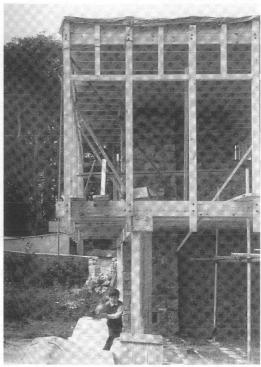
El pabellón en construcción. Detalles del apoyo del entramado de madera sobre la viga de hormigón armado. Simon Smithson jugando (Smithson y Smithson 1986)
